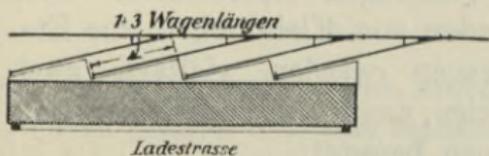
Güterschuppen (Grundriß) mit sägeförmigen Ladeeinrichtungen.
